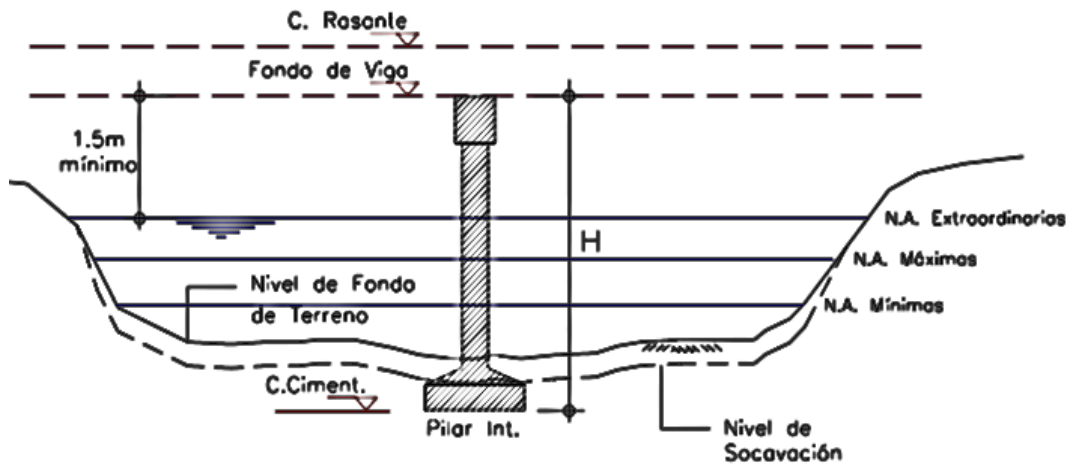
Esquema de niveles y ubicación del cimiento en pilar de un puente
